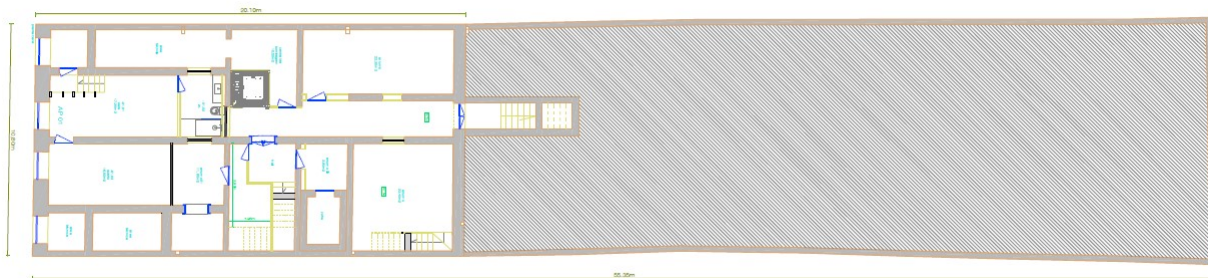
Planta de proposta de intervenção da cave (sem escala)
